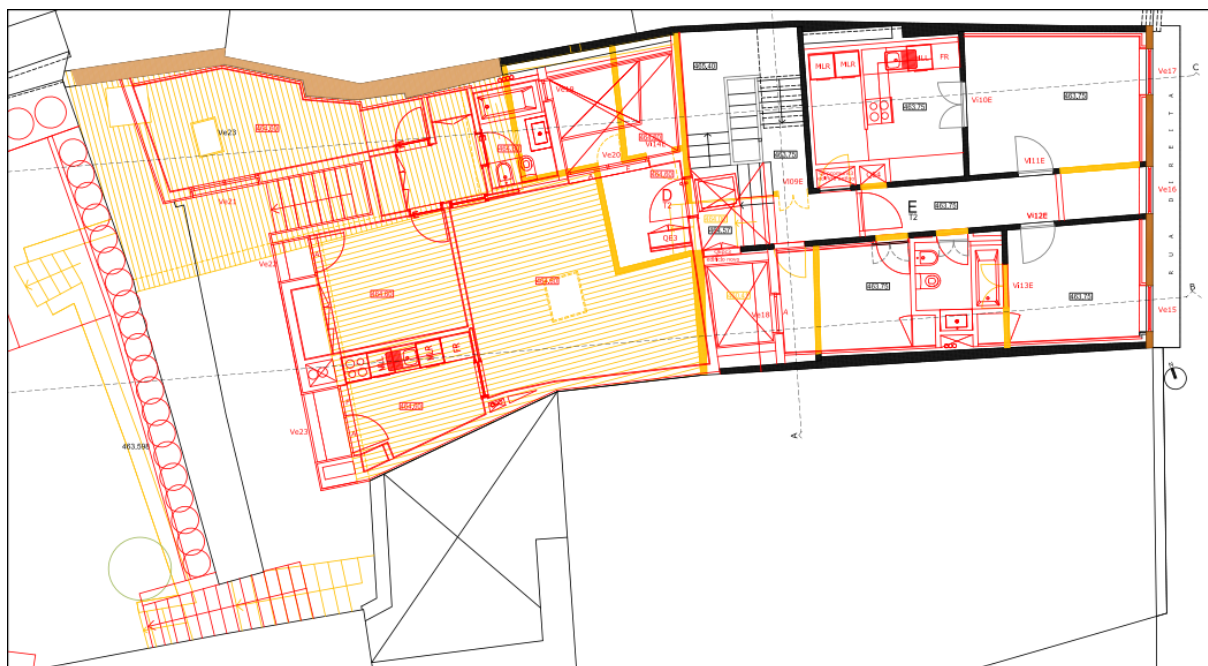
Planta do Piso 2 do edifício 2 em estudo
